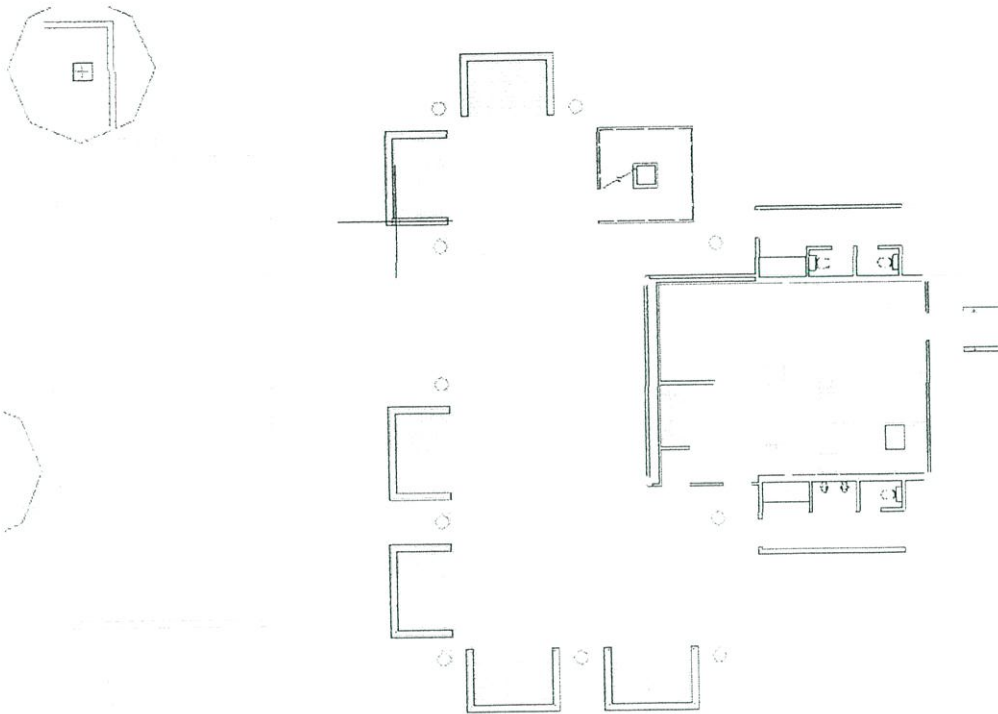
(บน) Lobby Building Plan, รูปที่ 6 (ล่าง) รูปอาคาร
